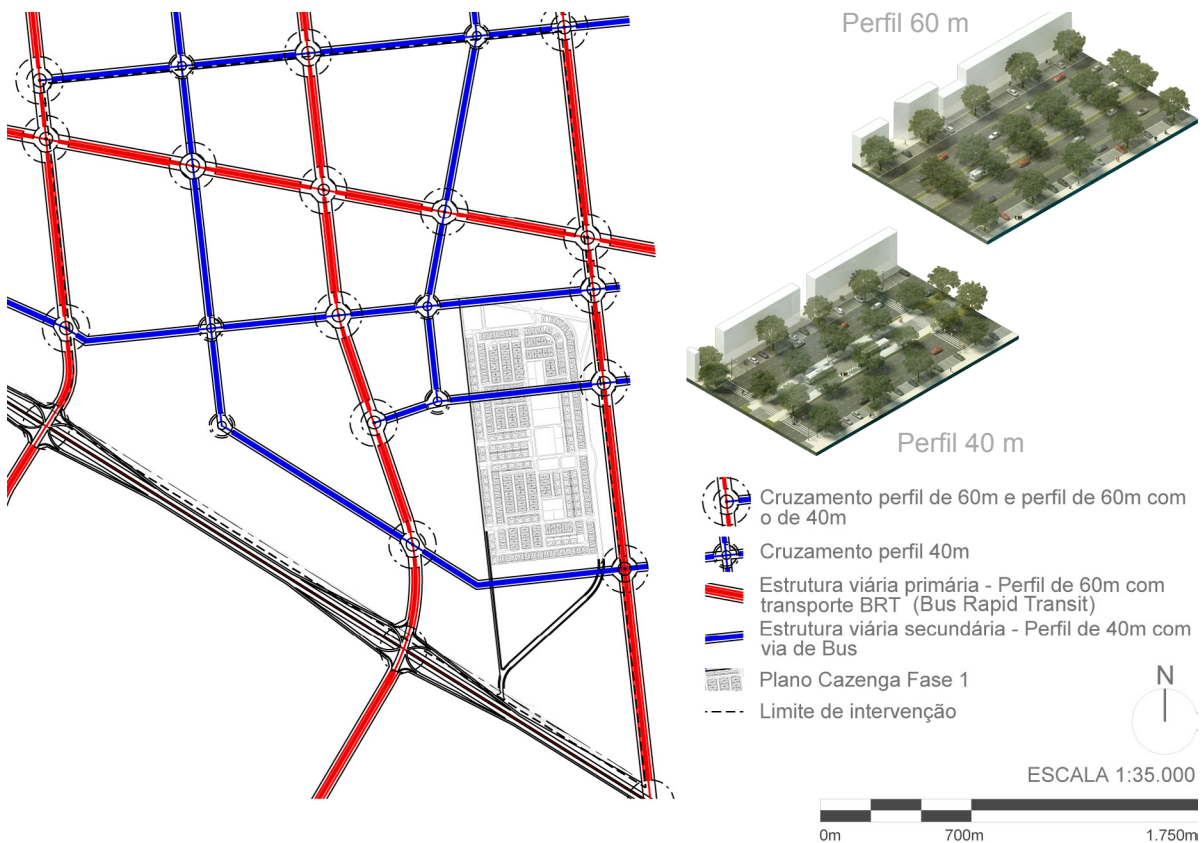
Proposta de alteração da estrutura viária e secções tipológicas de perfis de via com 60 m e 40 m de largura.
